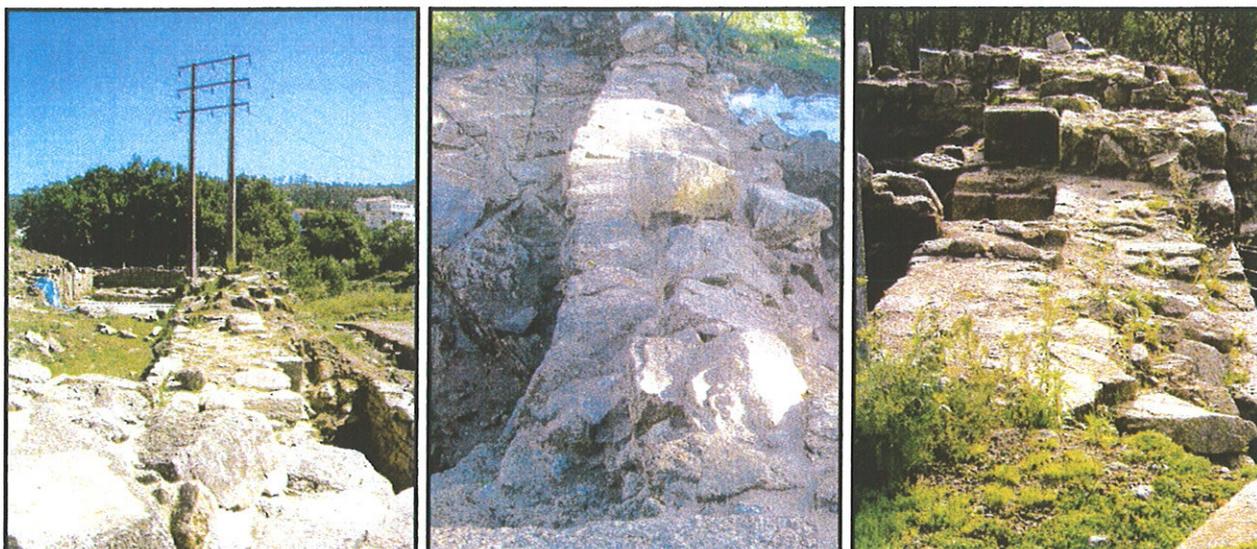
Vista argamasa durante fraguado en M1 al Norte.
